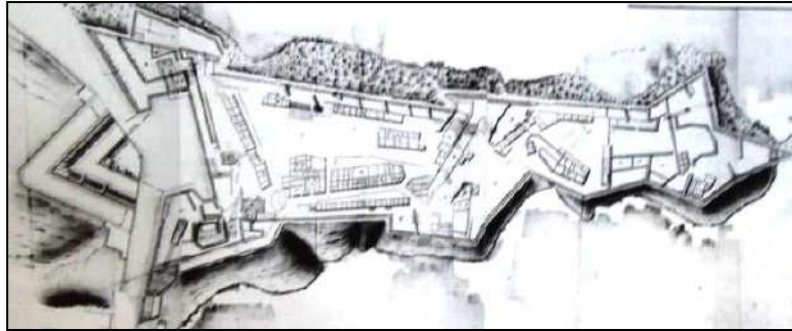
Plan du château de Mazalquivir (XVIII^e siècle)
